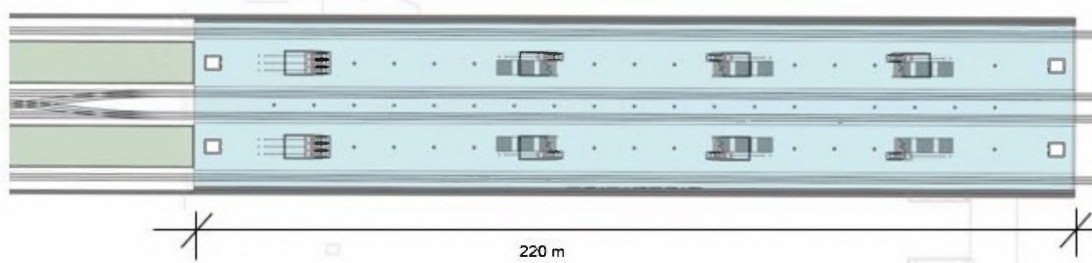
HP Altona Diebsteich Var. 1c – Grundrisse
